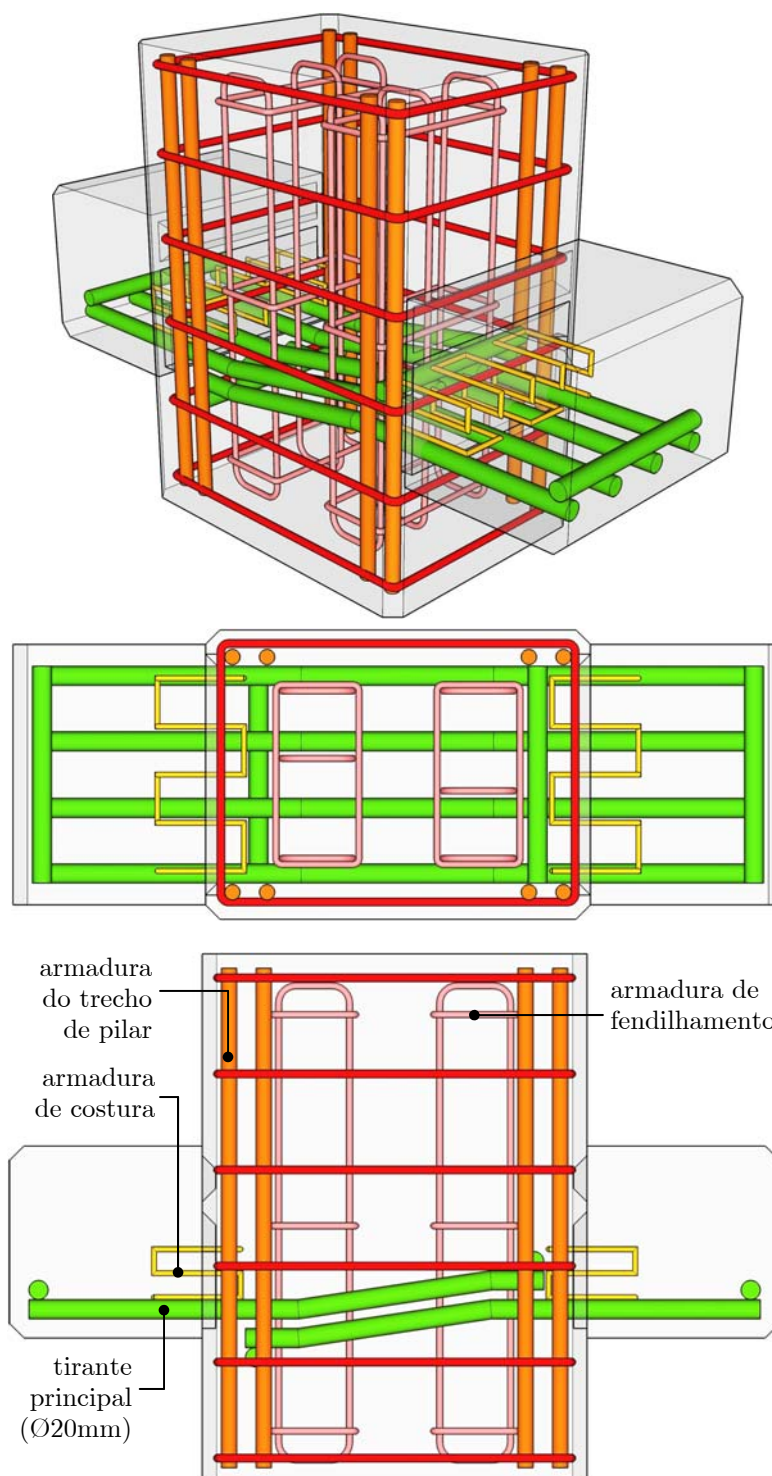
Detalhes das armaduras do modelo MAC6.
